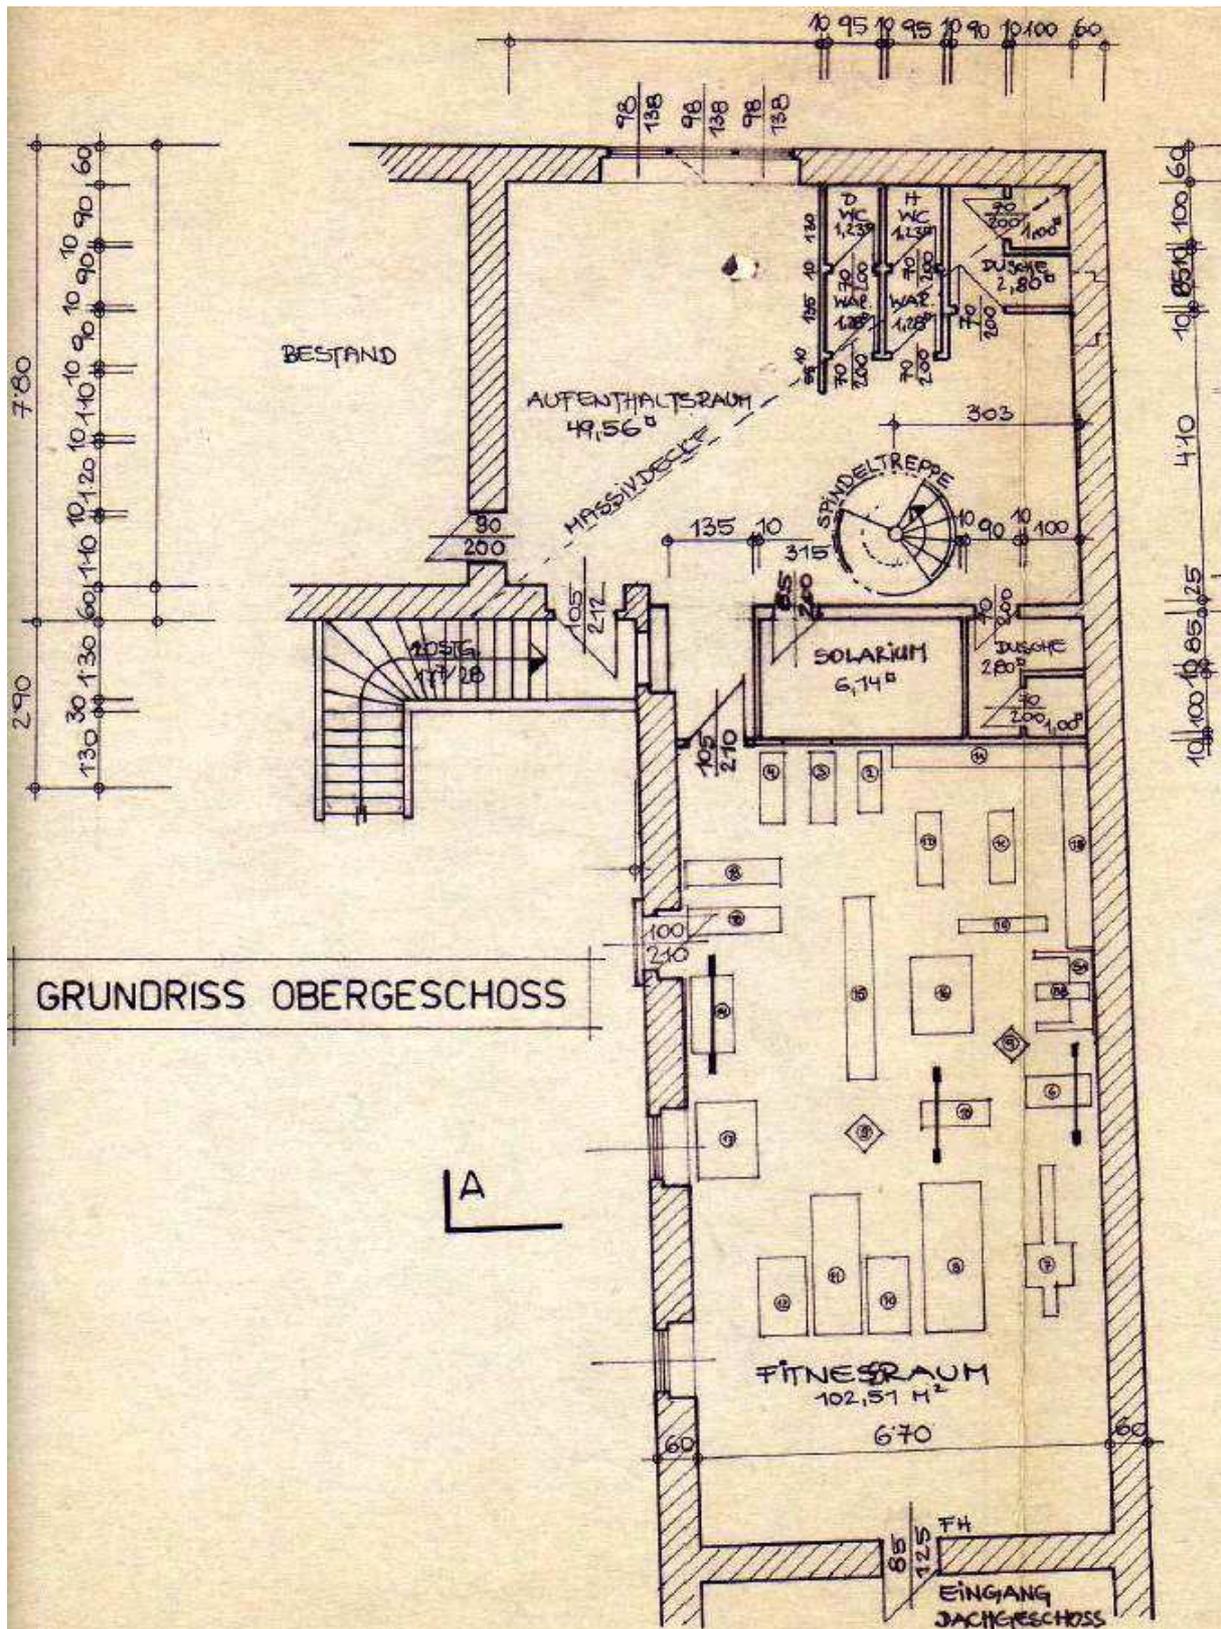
Grundriss Fitnessbereich OG Hoftrakt
